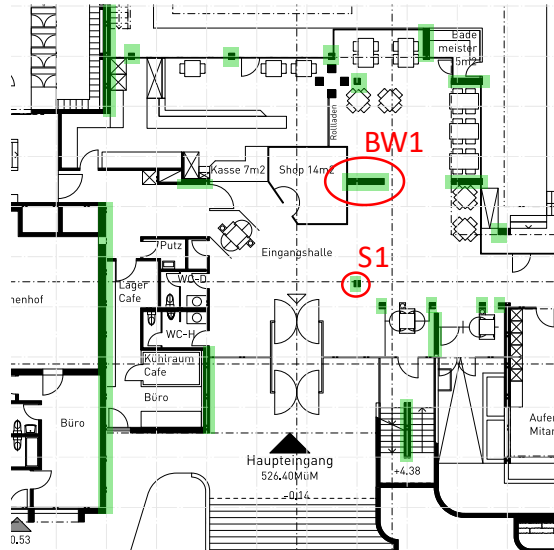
Untersuchte Betonwandscheibe und Stütze in der Eingangshalle
